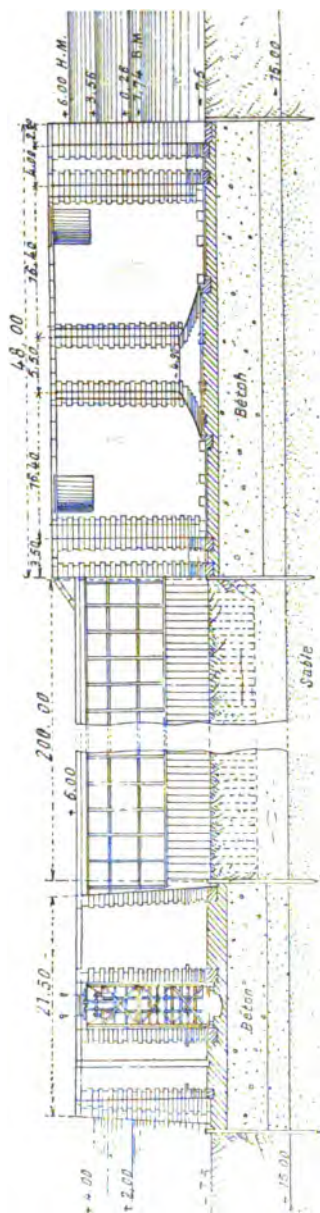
Bremerhaven. — Coupe longitudinale.
